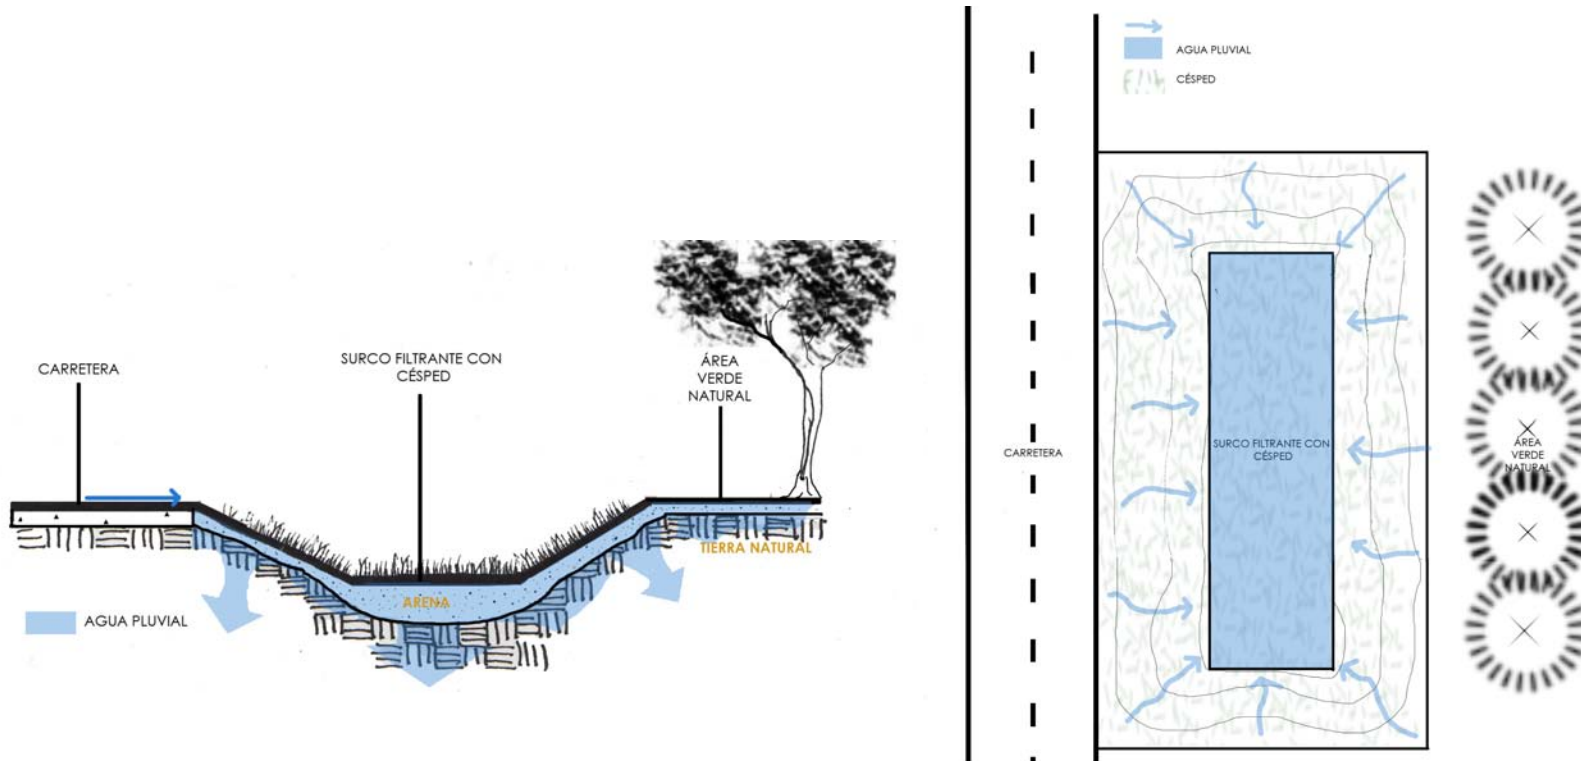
Corte y Planta de un Surco Infiltrante con Césped.
